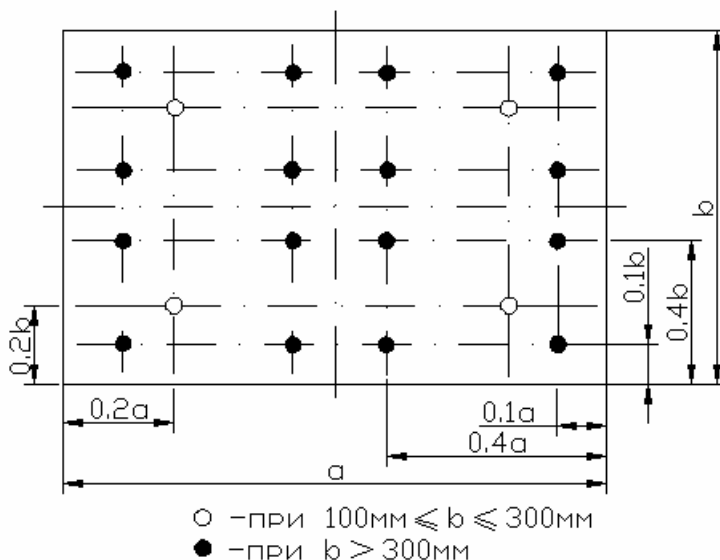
Схема точек замеров для воздухопровода прямоугольного сечения
